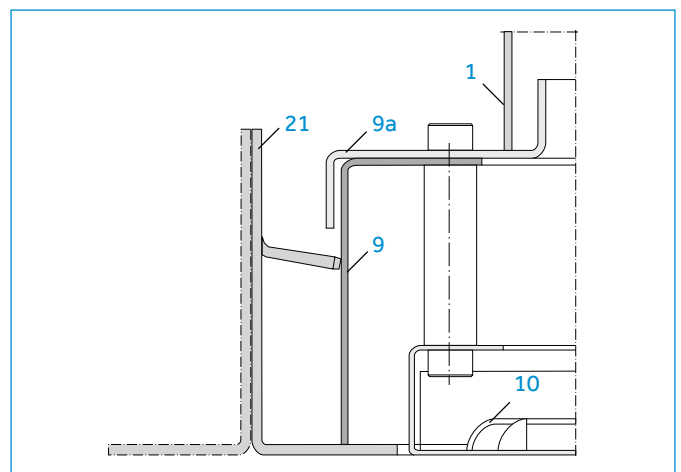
Installation Situation with ceiling installation frame 9 and intermediate profile 9a into a cassette ceiling type
